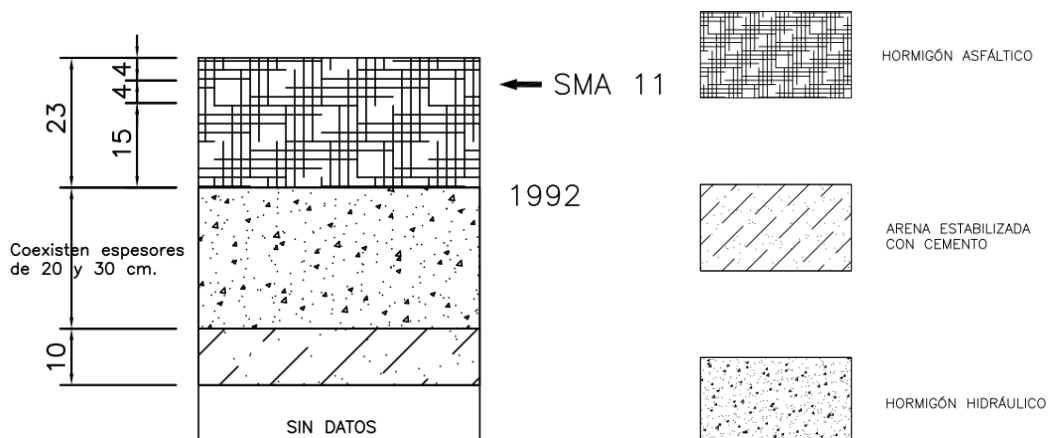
Sección teórica de pavimento de cabeceras 04 y 22. Fuente: Plano 05.01 del Manual del Aeropuerto
